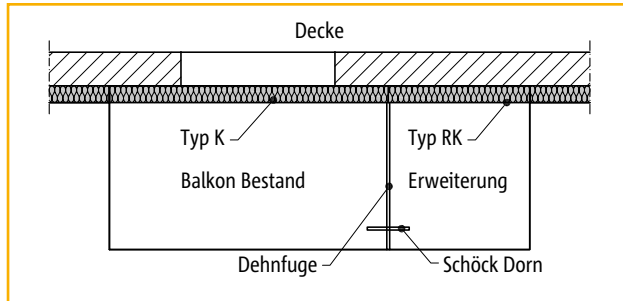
Balkon frei auskragend mit direkter Lagerung bei Erweiterung eines Bestandsbalkons - Grundriss
